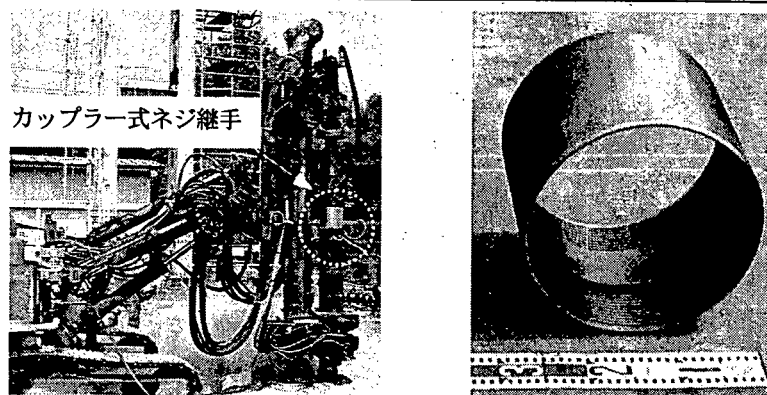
鋼管のカップラー式ネジ継手の例
